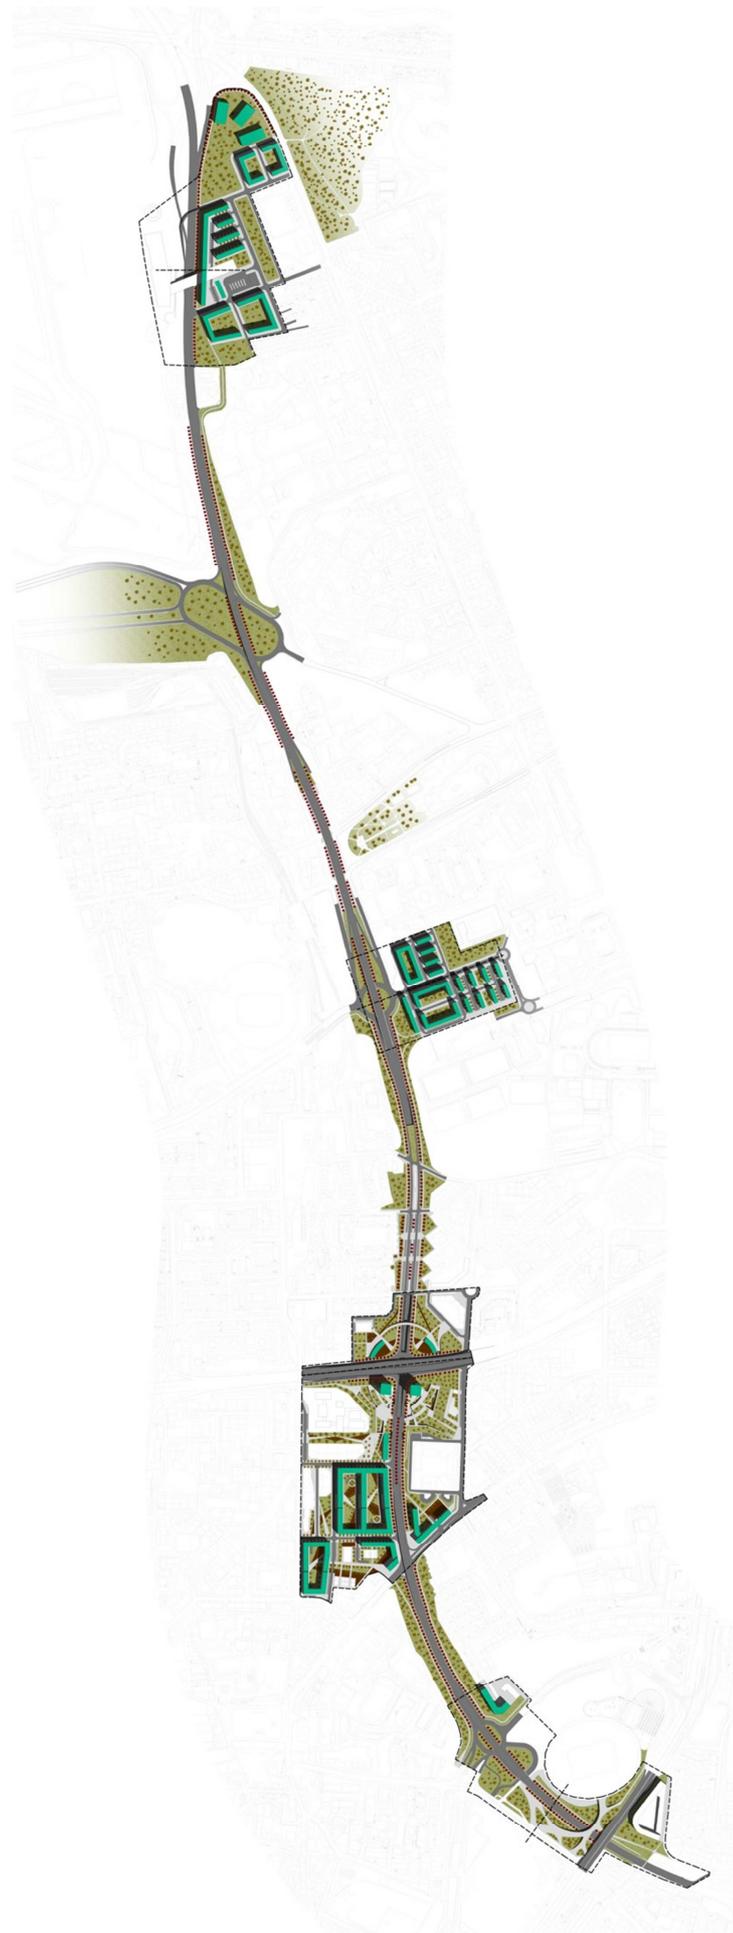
Plano geral de intervenção (Fonte: Autor)
